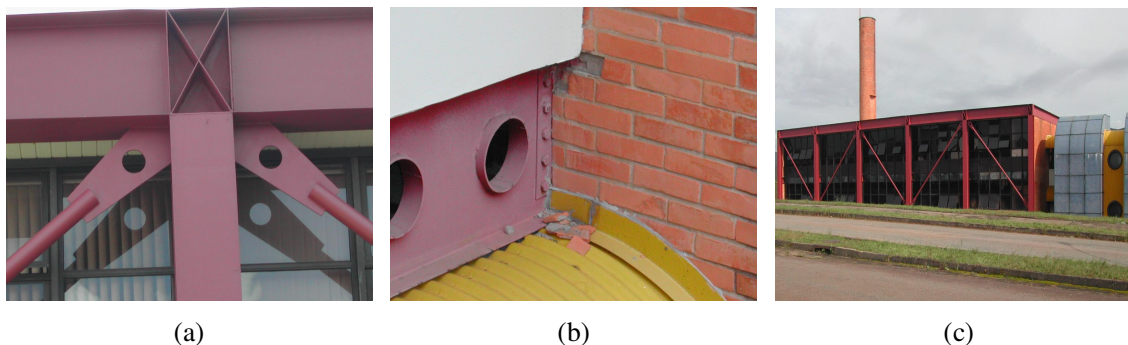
(a), vigas em ligação soldada (b), vigas em ligação parafusada (c), pintura marcante (c)
